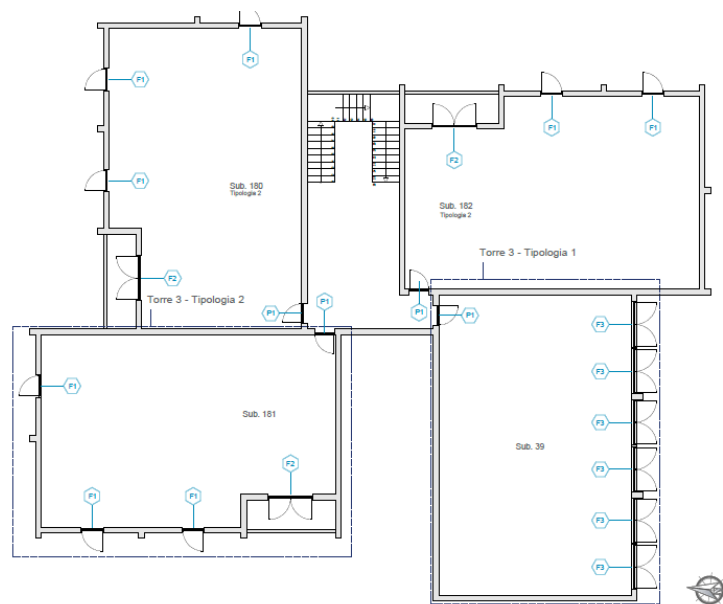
Pianta stato di fatto, piano primo – Torre 3
